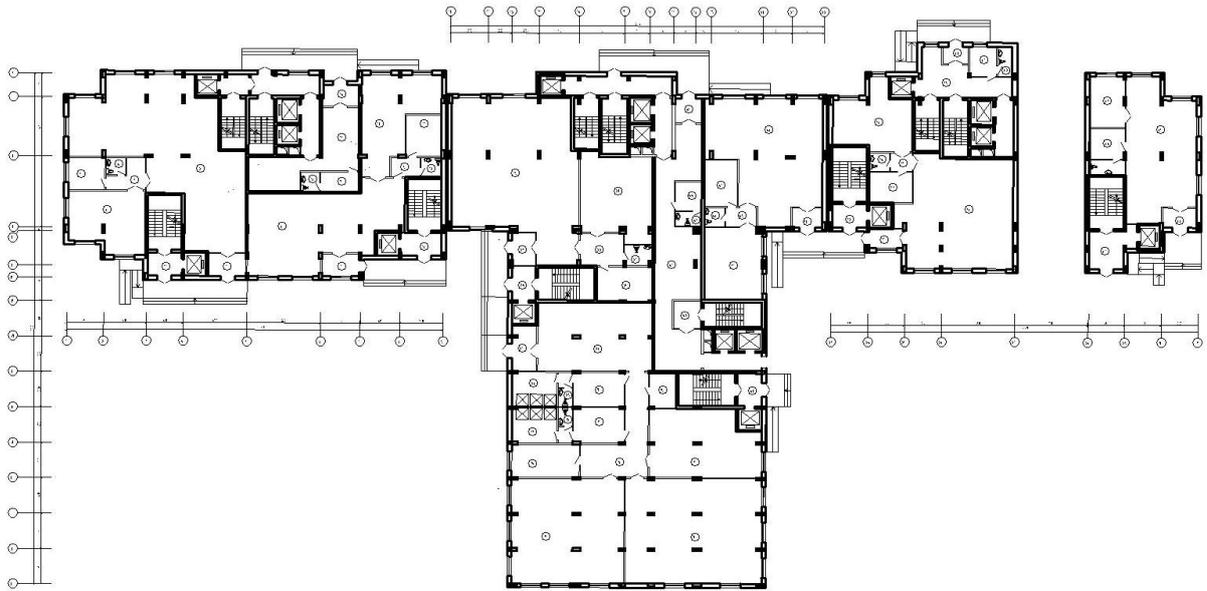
План 1 этажа на отметке 0,00 с помещениями общественного назначения
